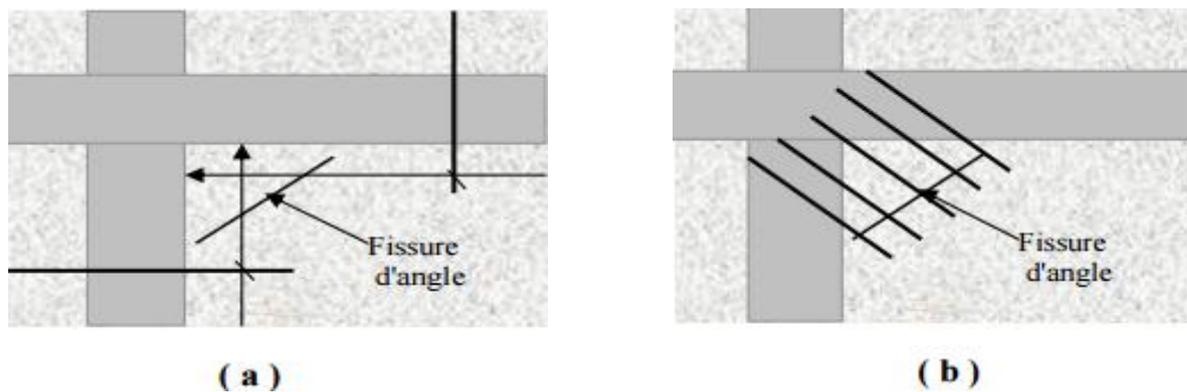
Fissuration à 45° d'une dalle, dispositions préventives du ferrailage
